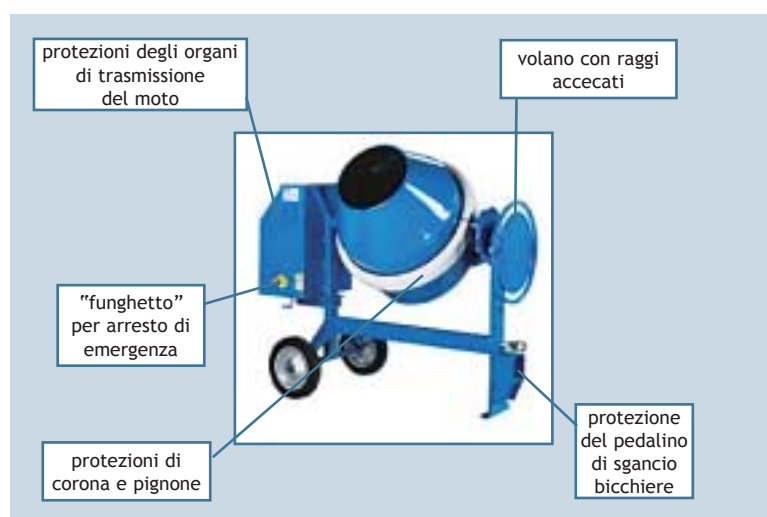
Elementi fondamentali di protezione della betoniera.
